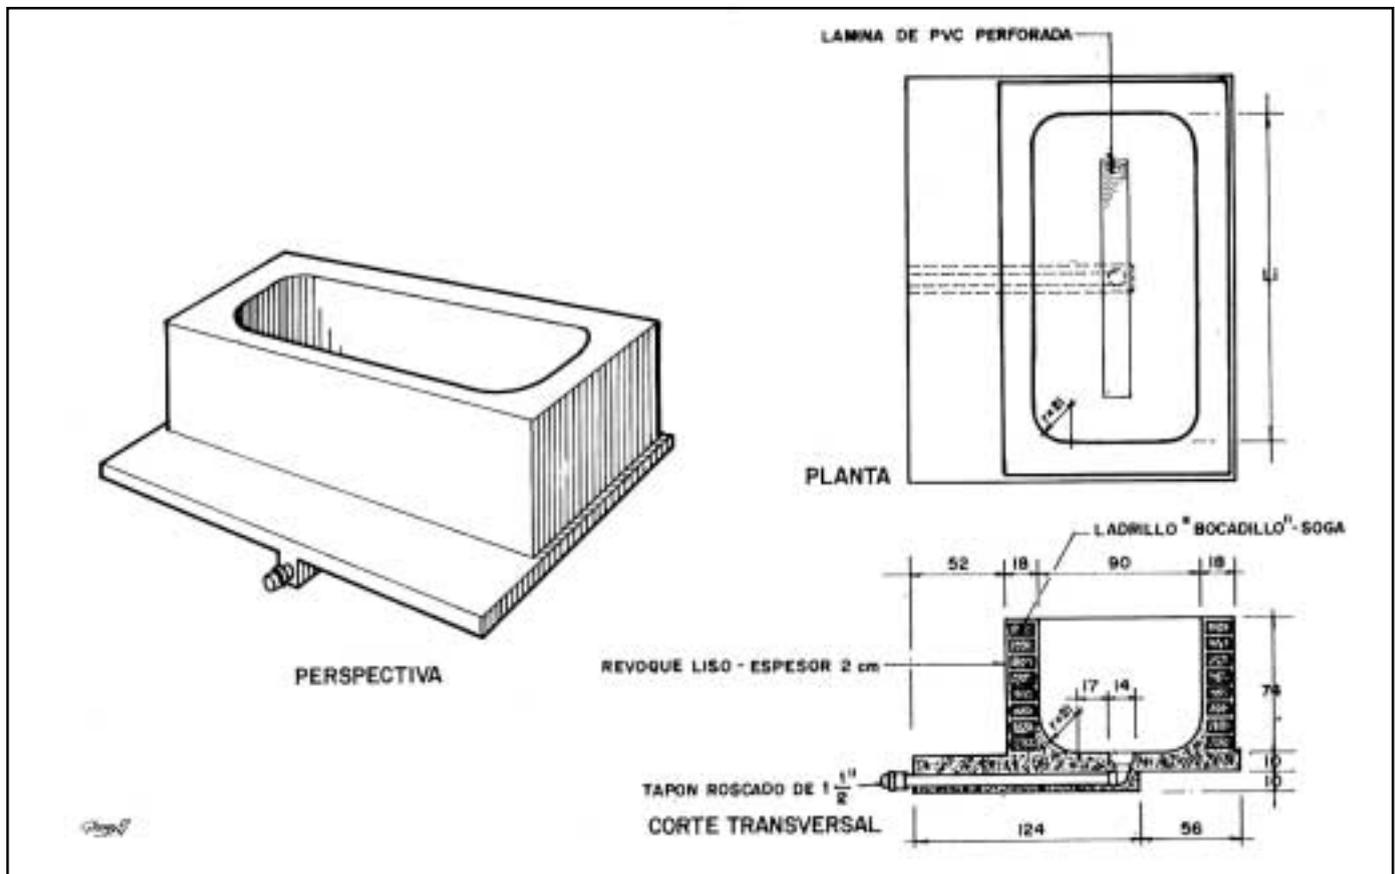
Dimensiones del TANQUE TINA (medidas expresadas en cm).
